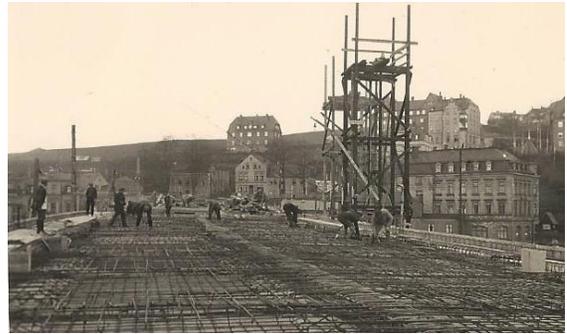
Armierung der Fahrbahndecke Teil C am 10.11.1936
